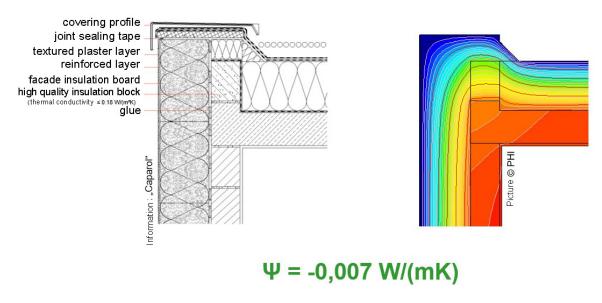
Montaje de parapeto de cubierta sin puente térmico.
